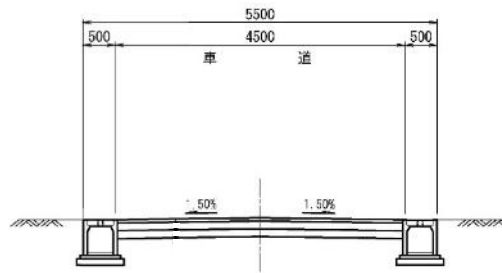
(5) 標準断面図 (区画道路 幅員 5.5m)
